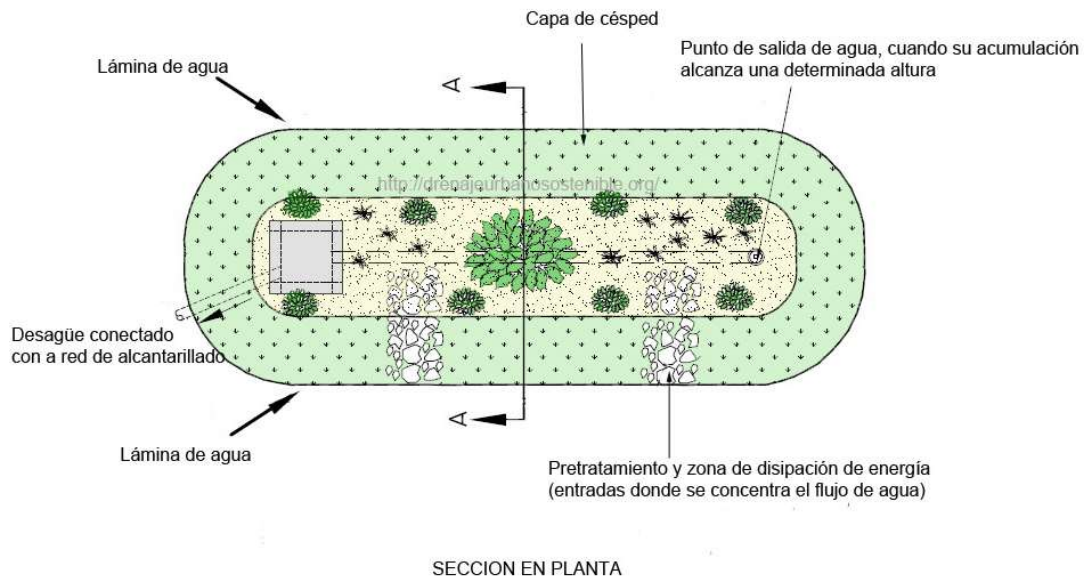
Sección en planta de un sistema de Área de Bioretención, (Fuente de www.suddostenible.com)
